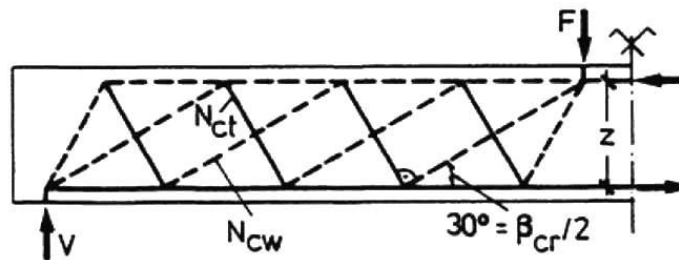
Modelo de armadura típico con tensores de concreto propuesto por Reineck (1991)
